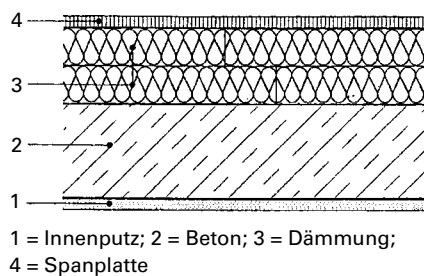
Stahlbetondecke mit begehbarer Dämmung
